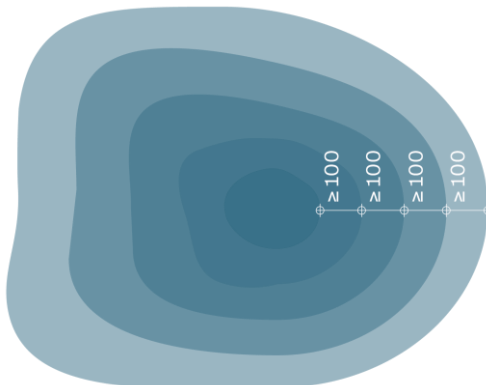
Grundriss Stufenbau (Masse in cm)
